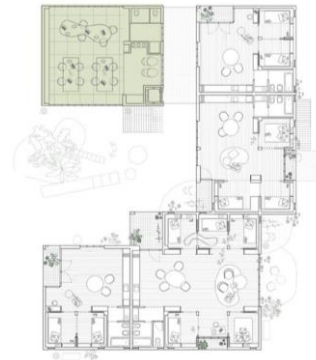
Recorte de la planta del conjunto de vivienda colectiva, indicando en color la herramienta utilizada. Fuente: Elaboración propia.
